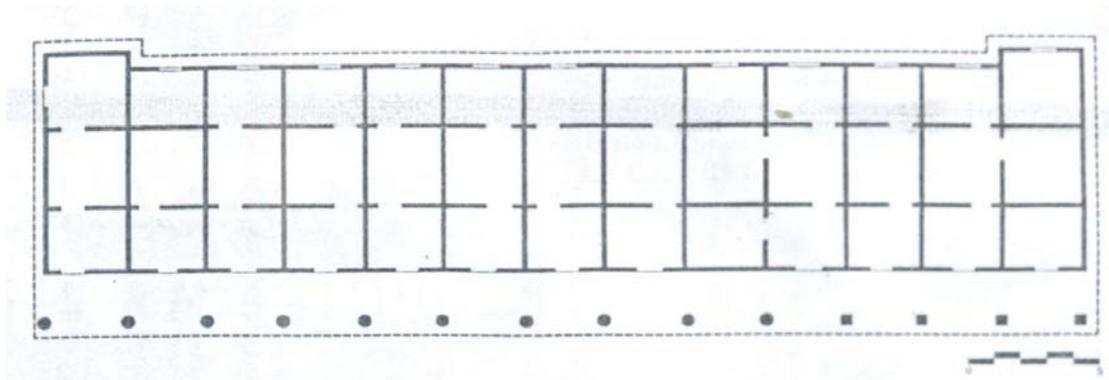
Planta Baixa. Compartimentos de, aproximadamente 3,0 m x 3,0m.
